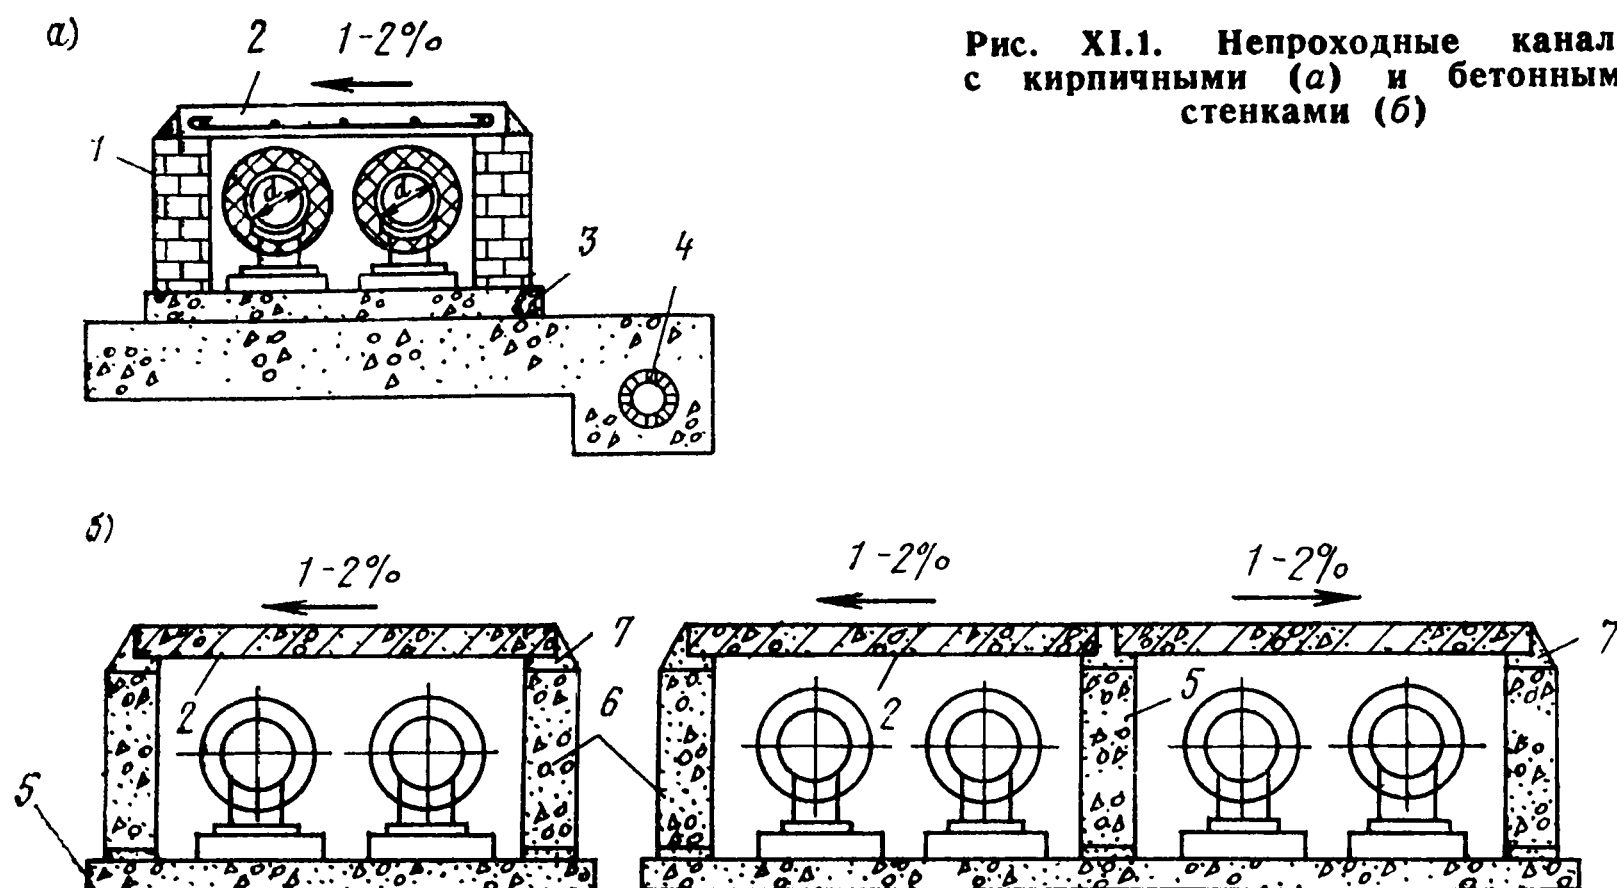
Непроходные каналы с кирпичными (а) и бетонными стенками (б)
